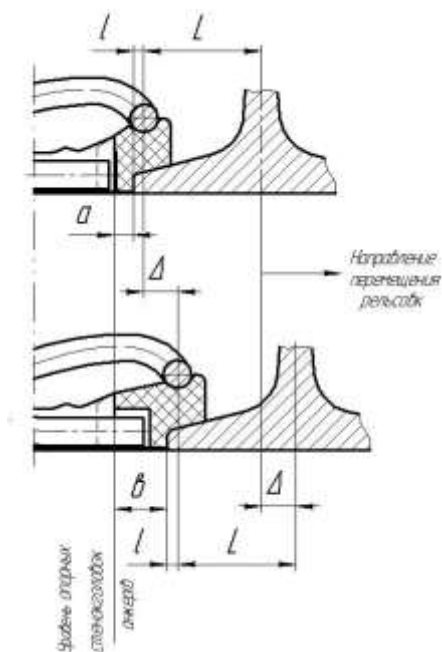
Схема регулирования ширины рельсовой колеи в системе промежуточного рельсового скрепления
